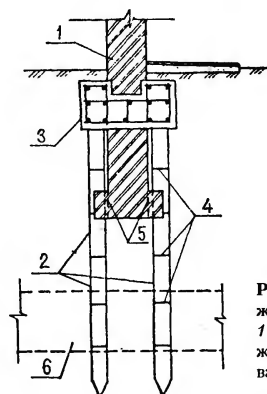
Передача нагрузки от стены на составные железобетонные сваи, погружаемые задавливанием
